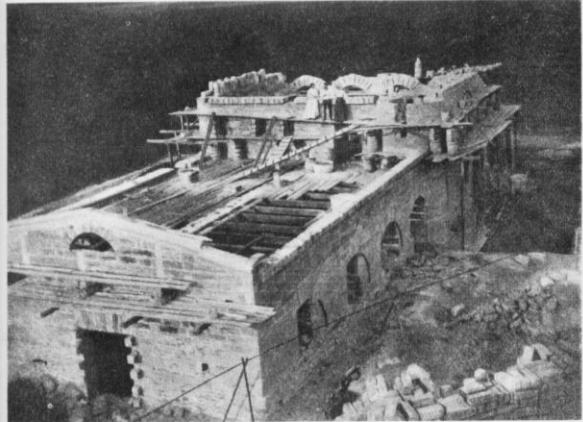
Подвалъ Станції. Каменная кладка близится къ концу. Одноэтажная часть подвала уже готова; ведется кладка продольныхъ стынъ дробильного отдѣленія, фронтонъ и верха круглой лѣстницы. Начата (первый планъ снимка) штукатурка фасада со входомъ въ подвалъ.
